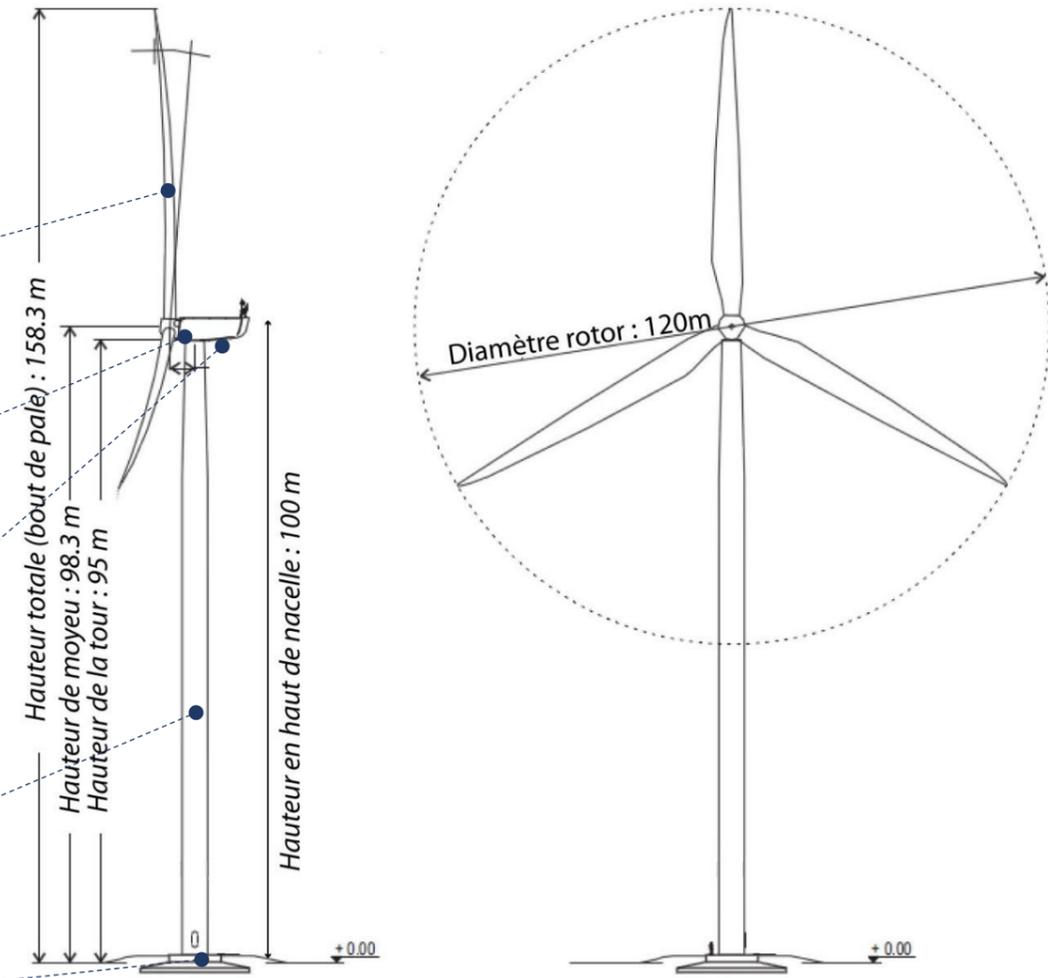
Plan d'élevation du gabarit-type d'éolienne prévu
